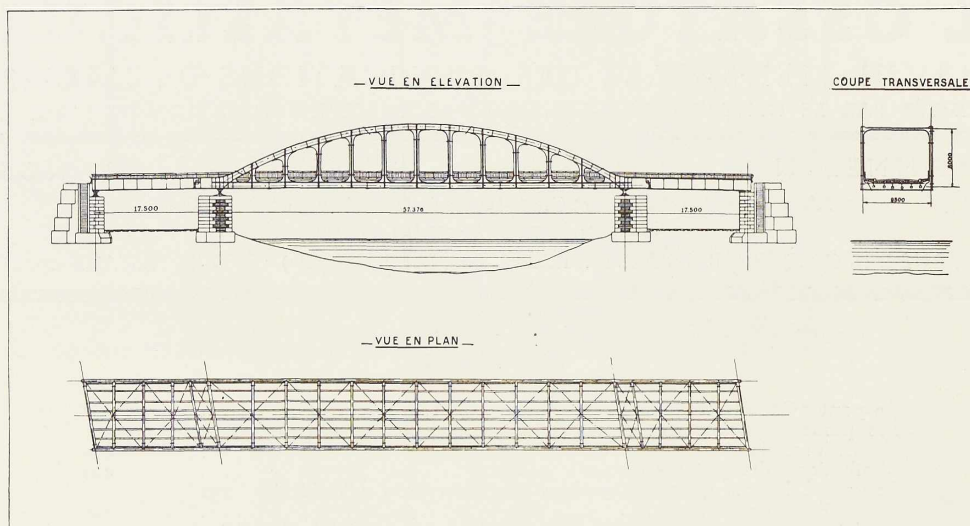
Elévation vue en plan et coupe du pont « C » d'Hérenthals.
